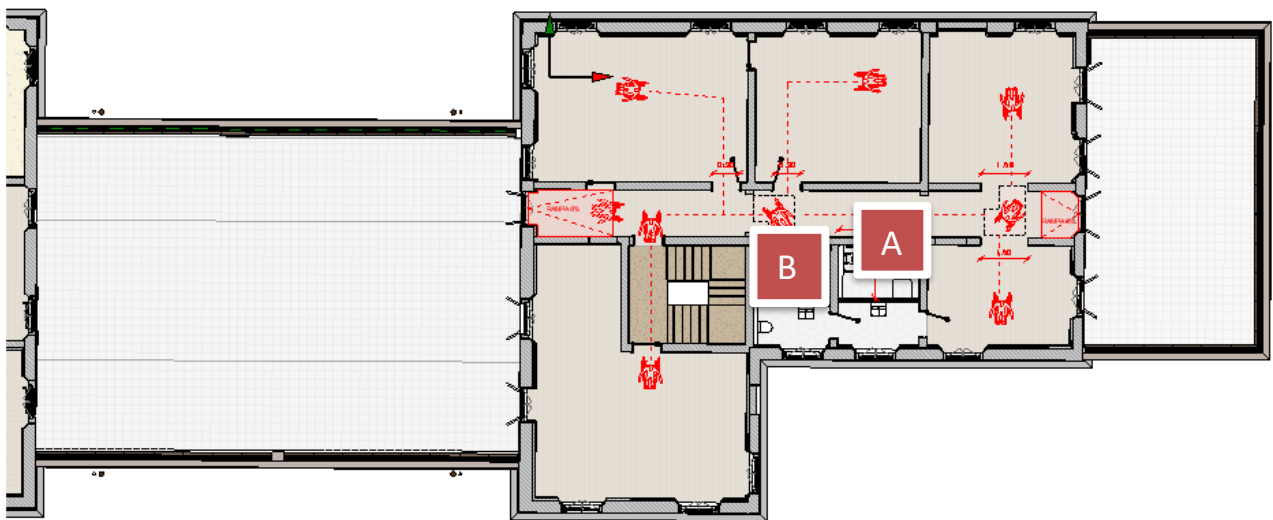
Estratto tavola di progetto – Edificio B pianta piano terra.
